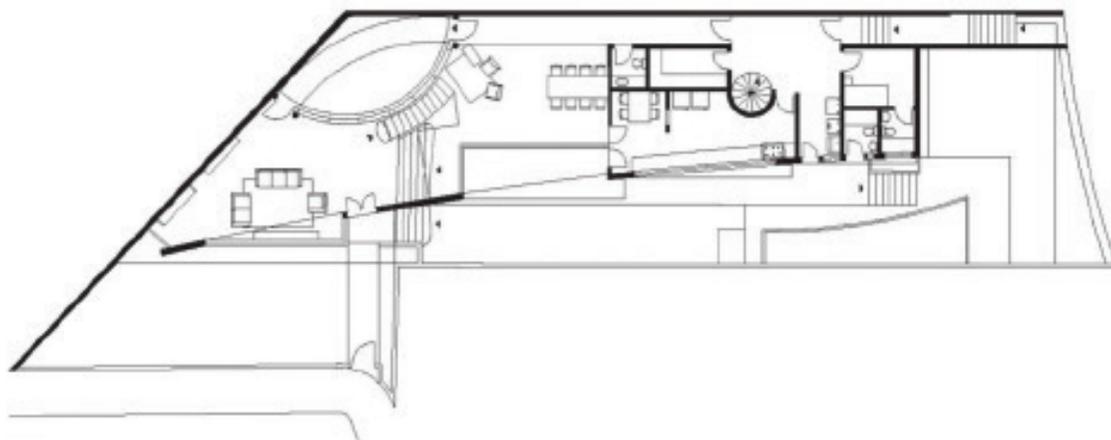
CASA DO MURO AZUL, CROQUI.
